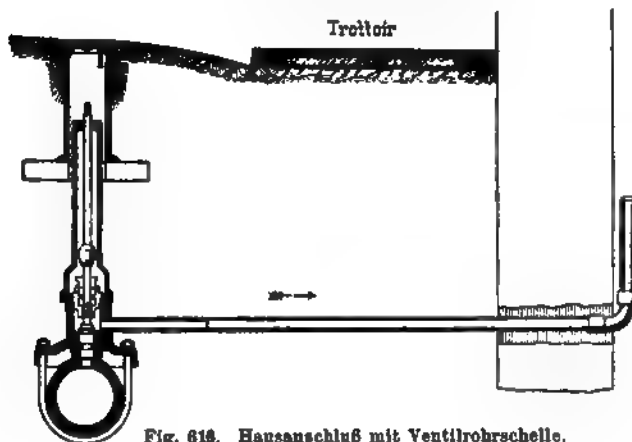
Hausanschluß mit Ventilrohrschelle.
